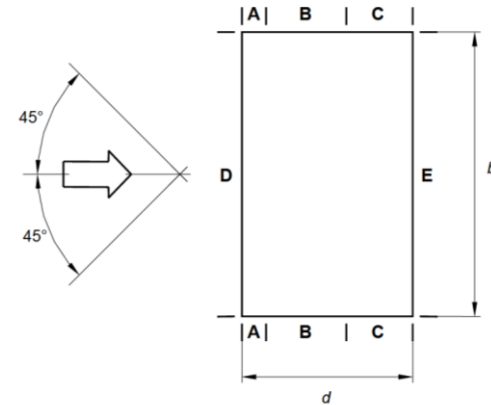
Suddivisione delle pareti verticali di edifici a pianta rettangolare in zone di uguale pressione (pianta).
